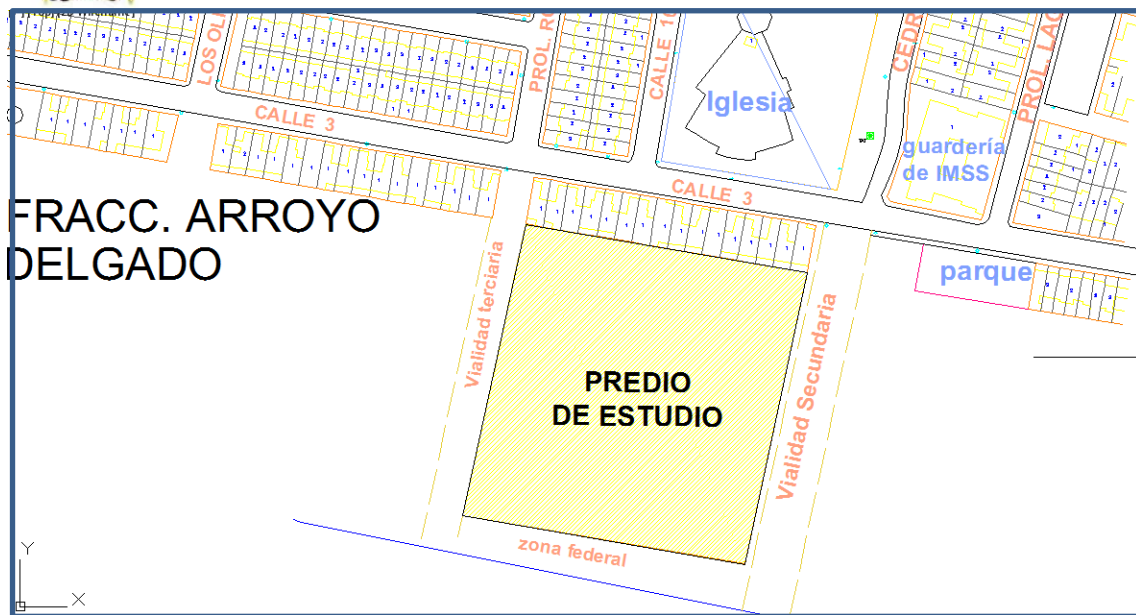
Ubicación del terreno y sus colindantes, planimetría de La Piedad
